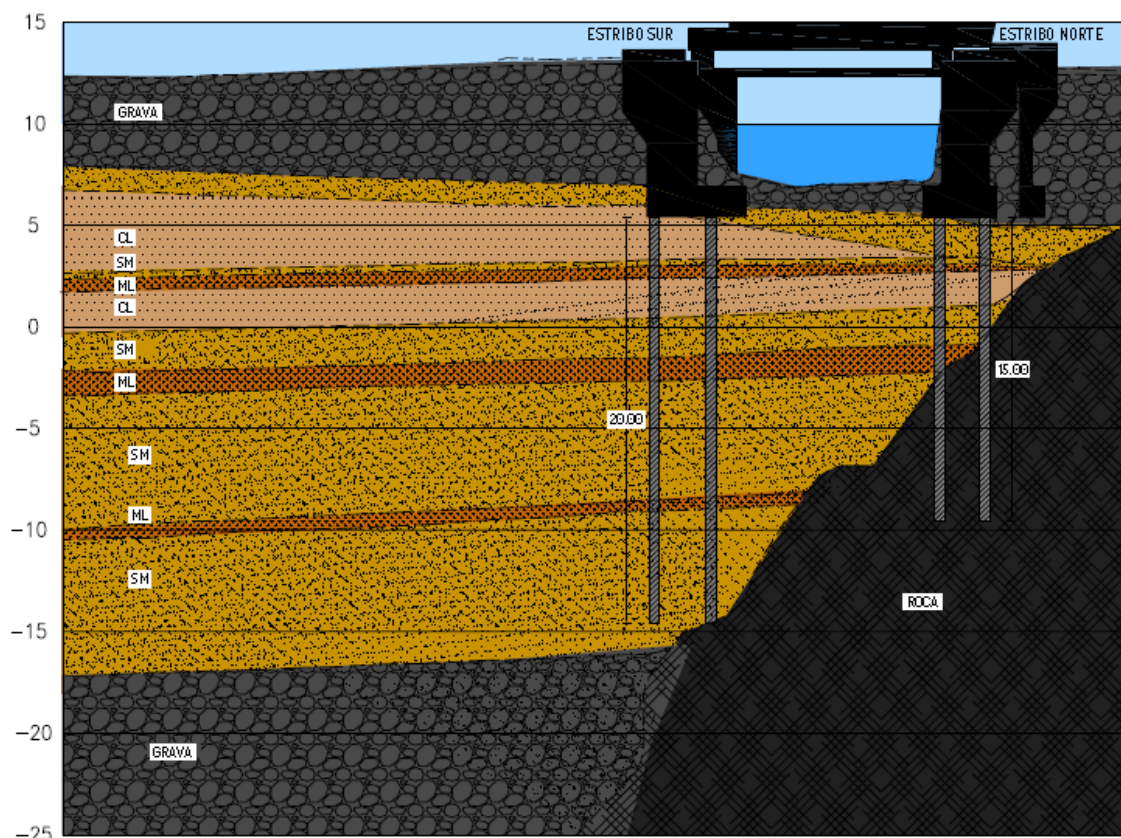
Perfil de suelo en los estribos norte y sur del puente Fortaleza.
